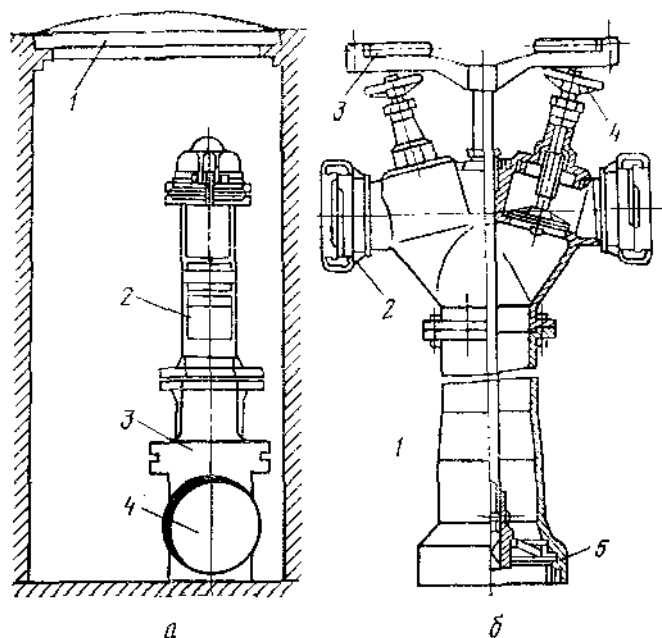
Устройство для отбора воды на пожаротушение из наружного водопровода:
